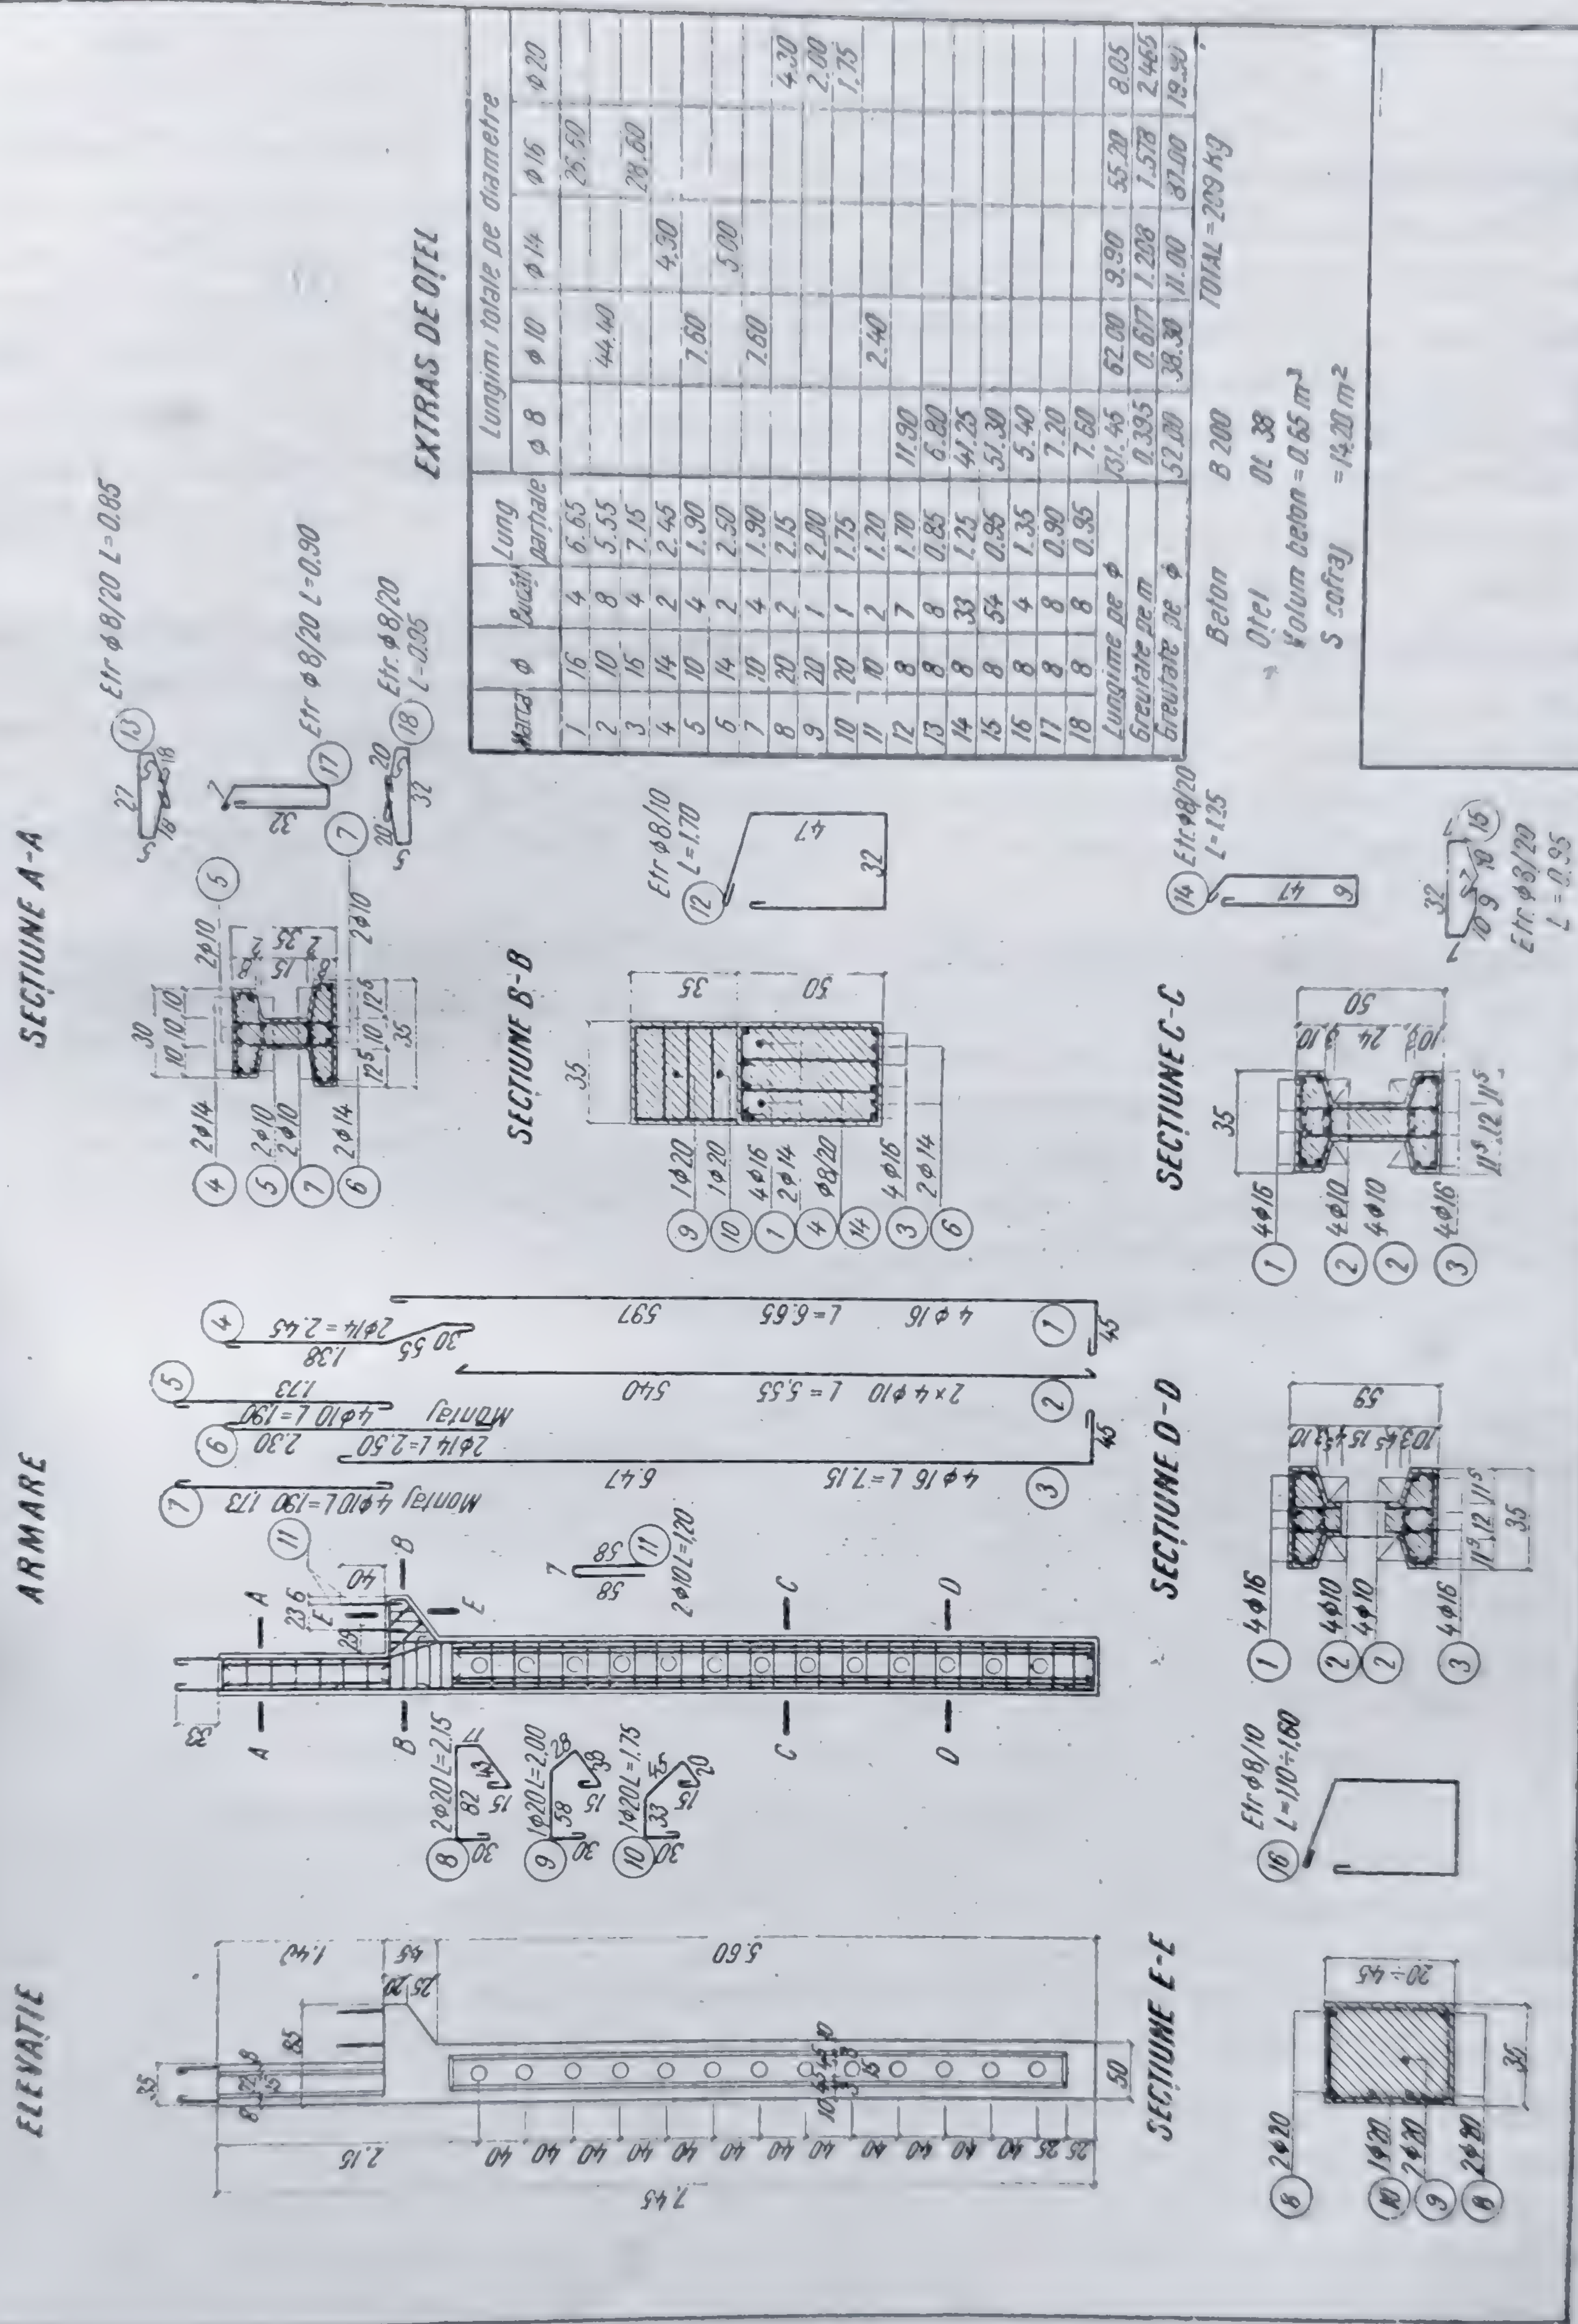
Desen pentru stîlp prefabricat de beton armat.
